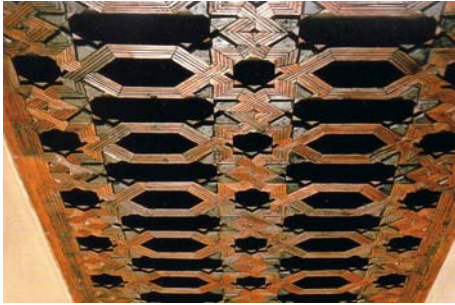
En esta imagen podemos observar claramente las distintas piezas necesarias para construir una armadura de lazo.¹⁹⁸
